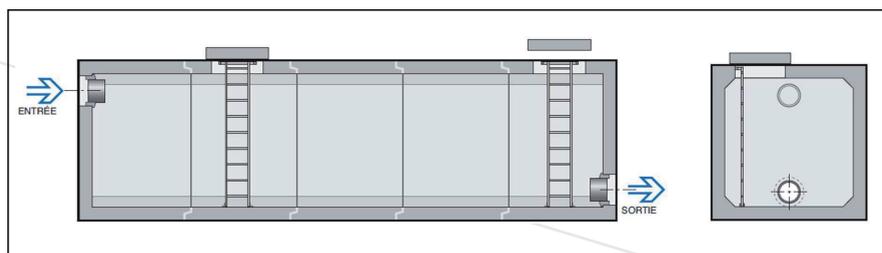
Vue de face d'un bassin de rétention en cadres préfabriqués en béton [Stradal]
